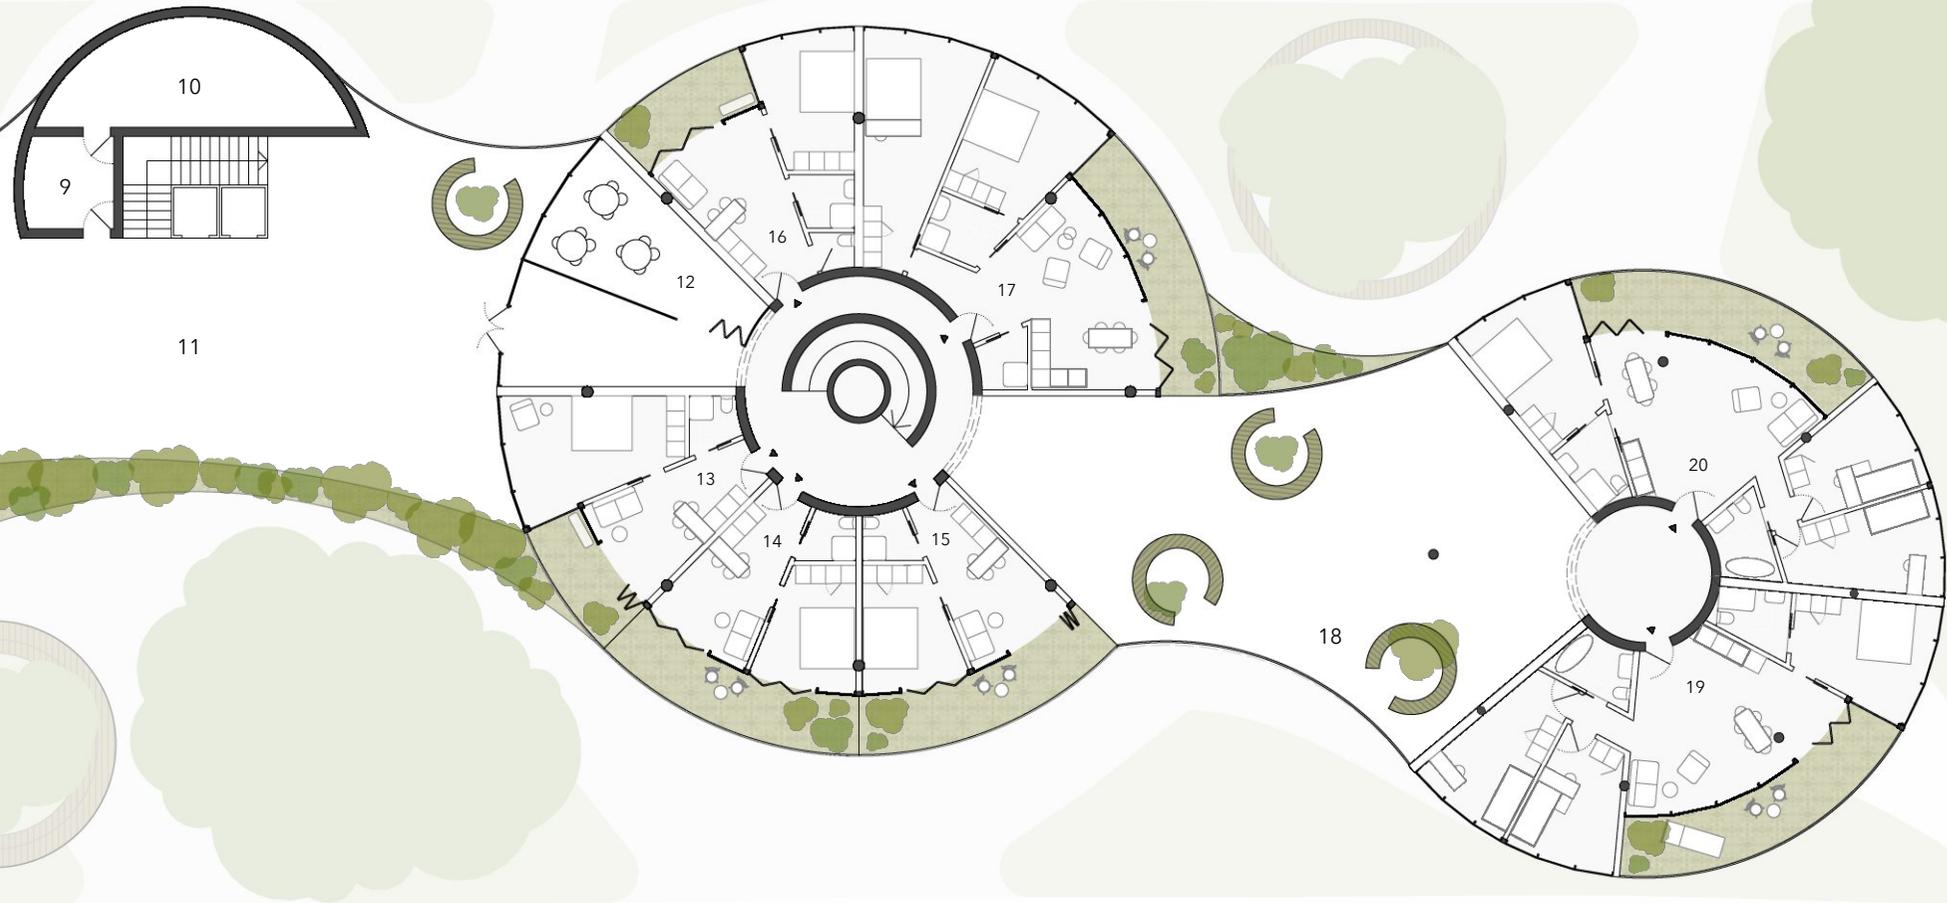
Grundriss 1. Obergeschoss
